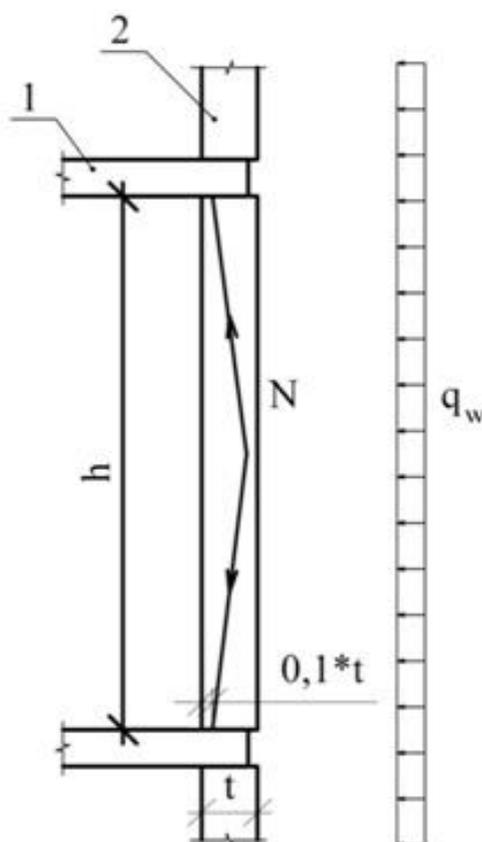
Арочный эффект в защемленном лицевом слое от действия ветровой нагрузки: 1 – плита перекрытия, 2 – лицевой слой.
